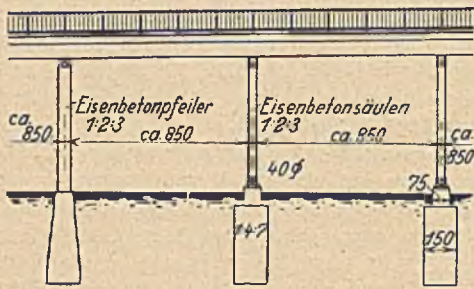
a. Brücke über dem Bahngelände, Ansicht.
